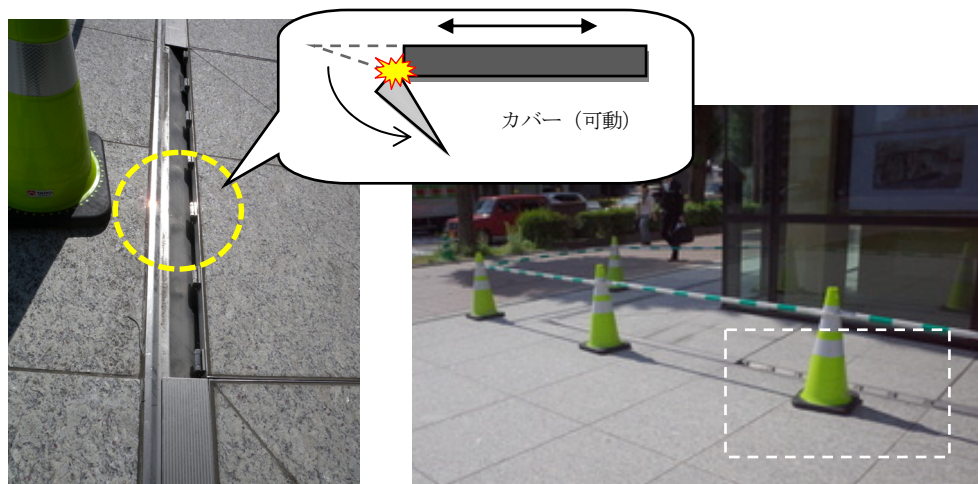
外周部エクspansionカバーの変状（左図は右図囲み部の拡大）
